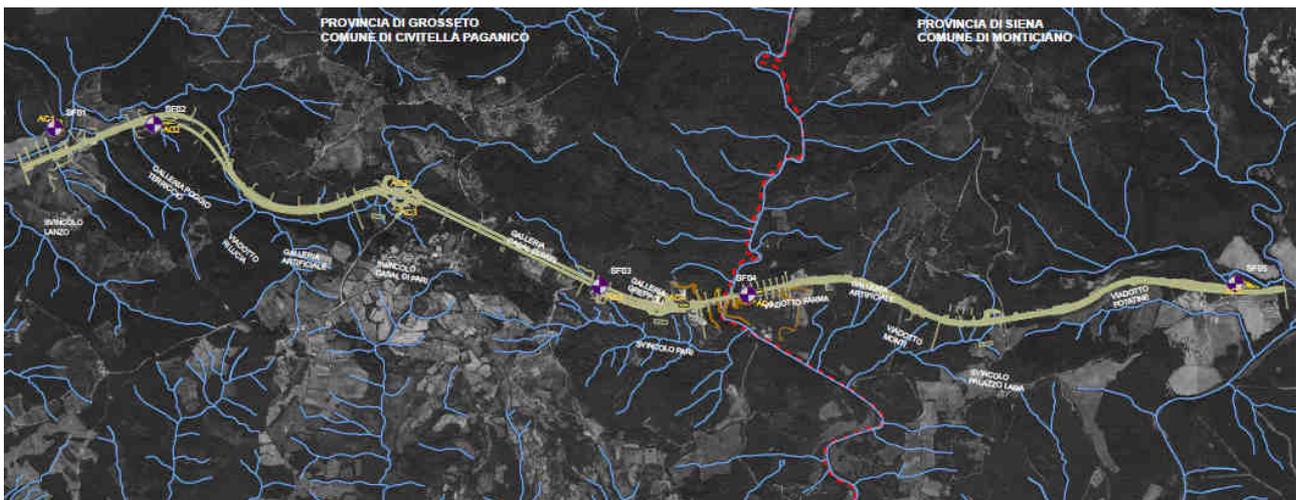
Planimetria generale – Stato fisico dei luoghi
